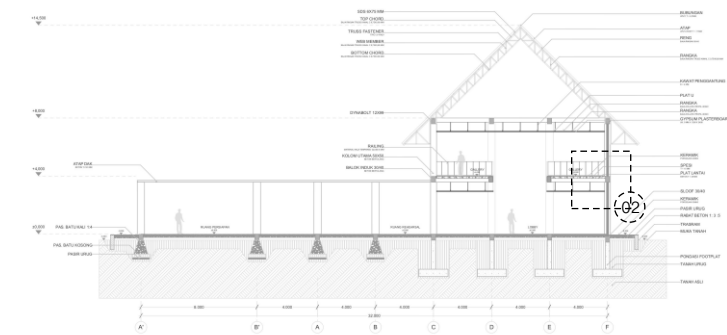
Potongan s-04 bangunan teater (Sumber: Penulis, 2021)
